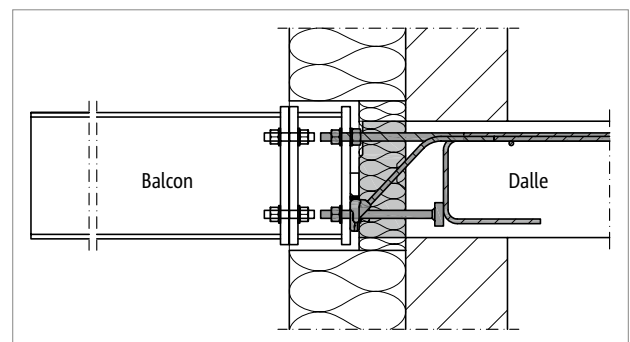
Schöck Isokorb® T type SK : Raccordement de la poutre en acier à un adaptateur compensant l'épaisseur de l'isolation externe
